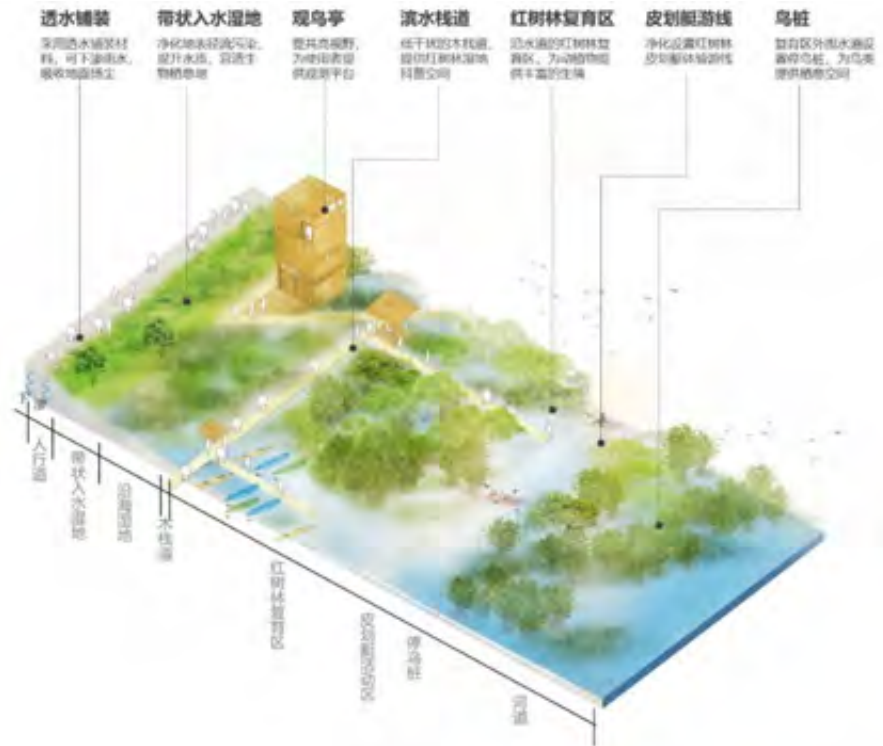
鸡啼门红树秘境节点典型剖面图
